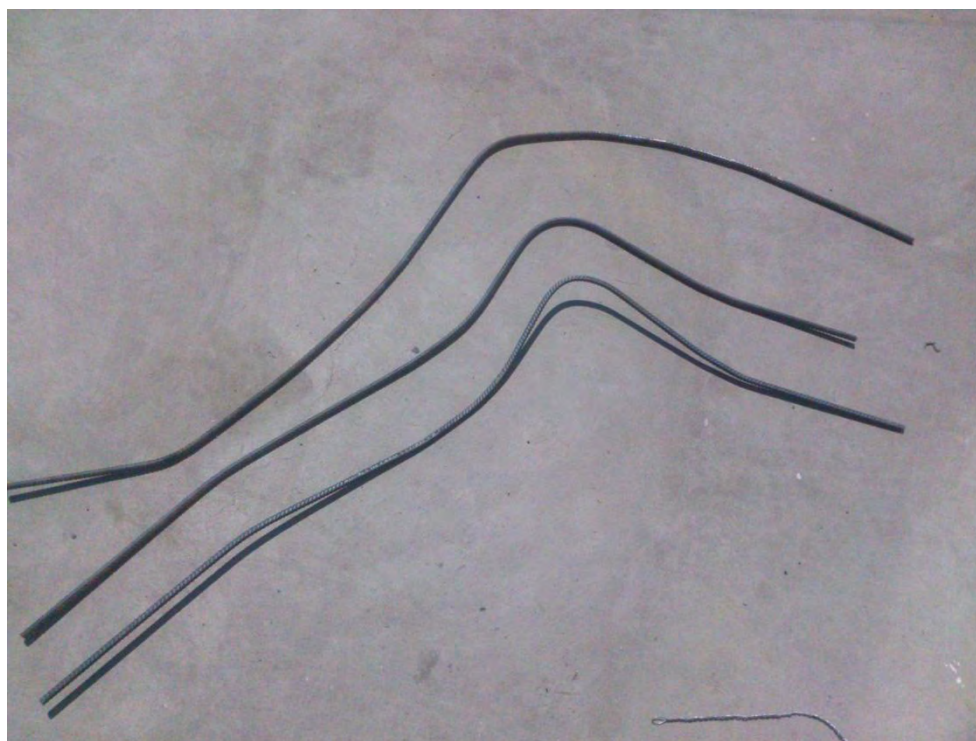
DOBLADO DE BARRAS LONGITUDINALES PIERNA
